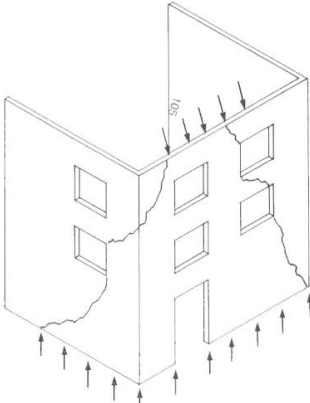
Fissuração típica nos cantos das aberturas, sob atuação de sobrecargas.
